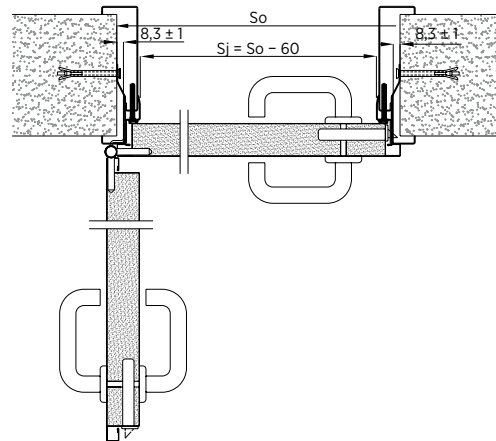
Montage d'un bloc-porte à un battant avec bâti enveloppant - coupe horizontale
